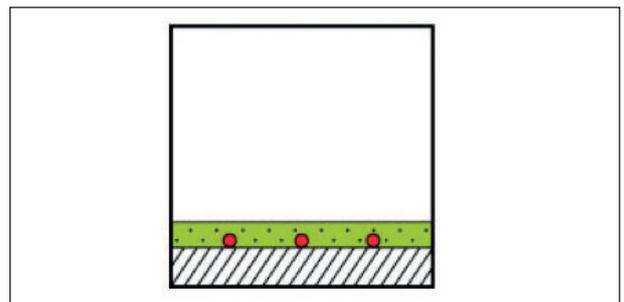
NB3 – Verbundkonstruktion: Rohrsystem auf Altuntergrund in Ausgleichsmasse/estrich
